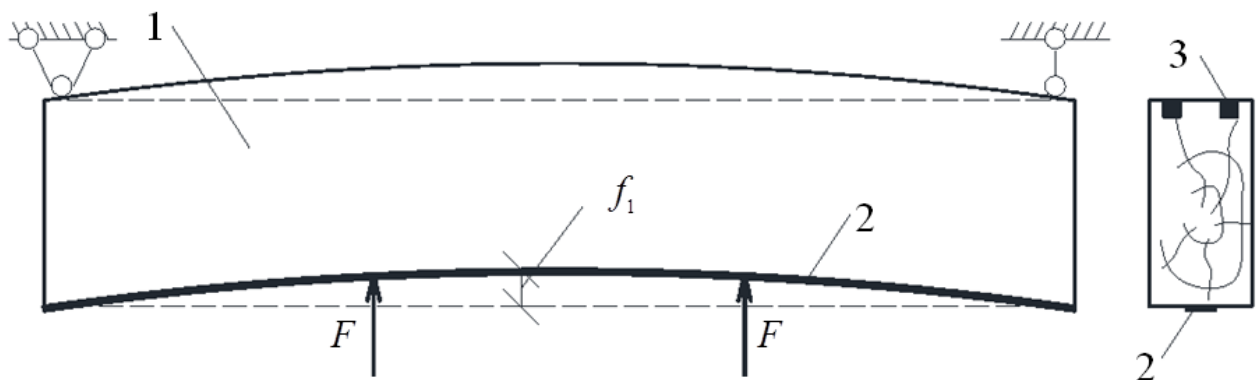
Схема попереднього напруження згинального дерев'яного елемента з одночасним вклеюванням арматури в стиснуту та розтягнуту зони для надання попереднього напруження: 1 – згинальний дерев'яний елемент; 2 – арматура розтягнутої зони; 3 – арматура стиснутої зони
